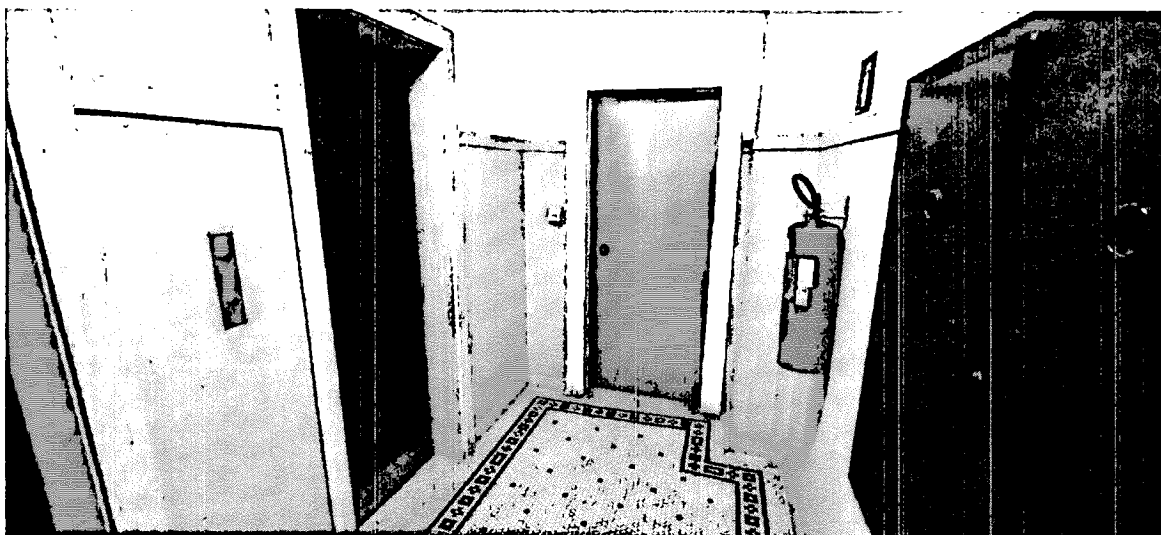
Hall do 2º pavimento – Fonte: Autor
